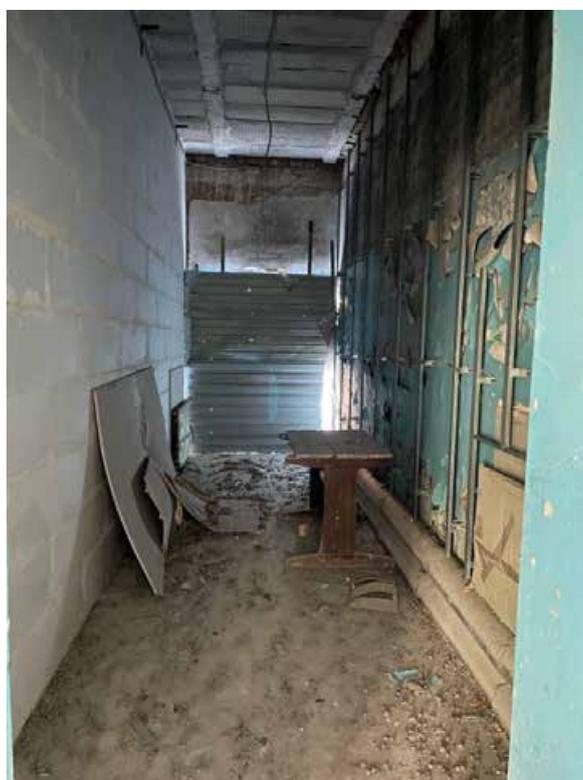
, 2.10. 2 этаж. Помещения по западному фасаду.
